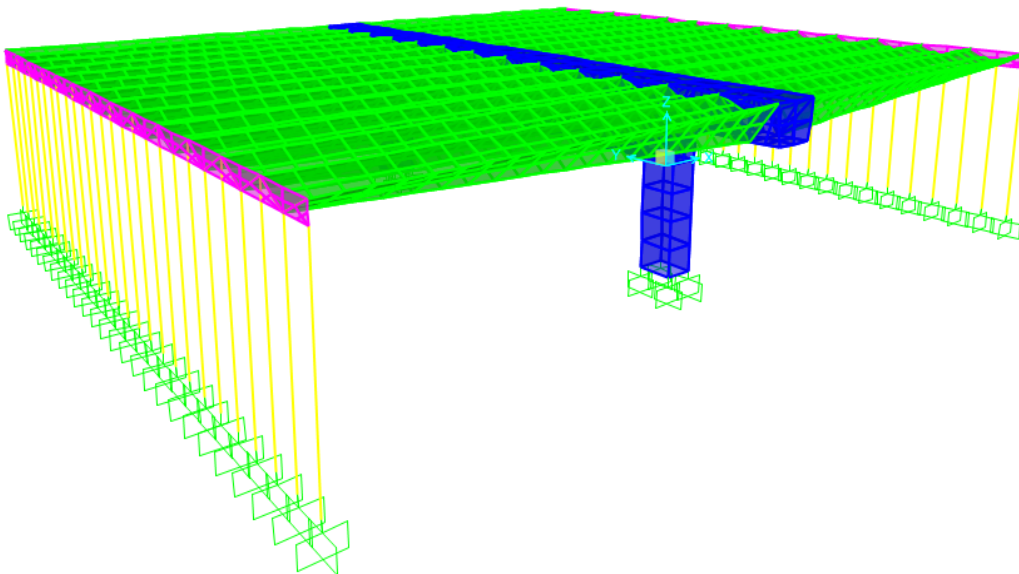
Modélisation des poteaux métalliques des deux façades
